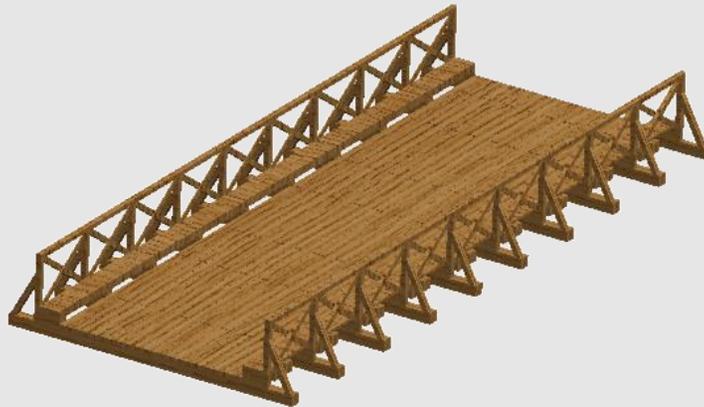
Vista isométrica tablero para puente sobre vigas metálicas - ancho de calzada 3,6 m
